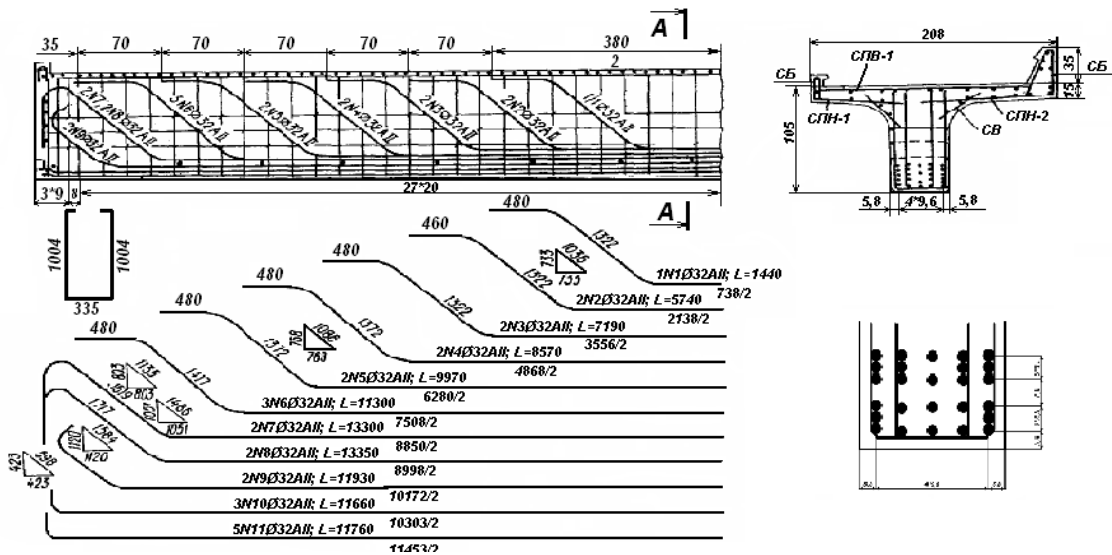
Армування ребристої прогонної будови з ненапруженою арматурою
